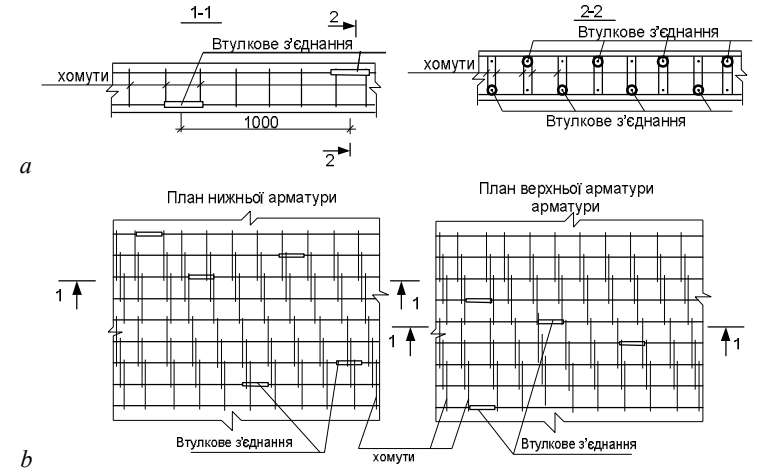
Армування плити проїжджої частини мосту стержнями, що з’єднані з допомогою обтискної втулки: а – поздовжній розріз плити; б – поперечний розріз плити.
